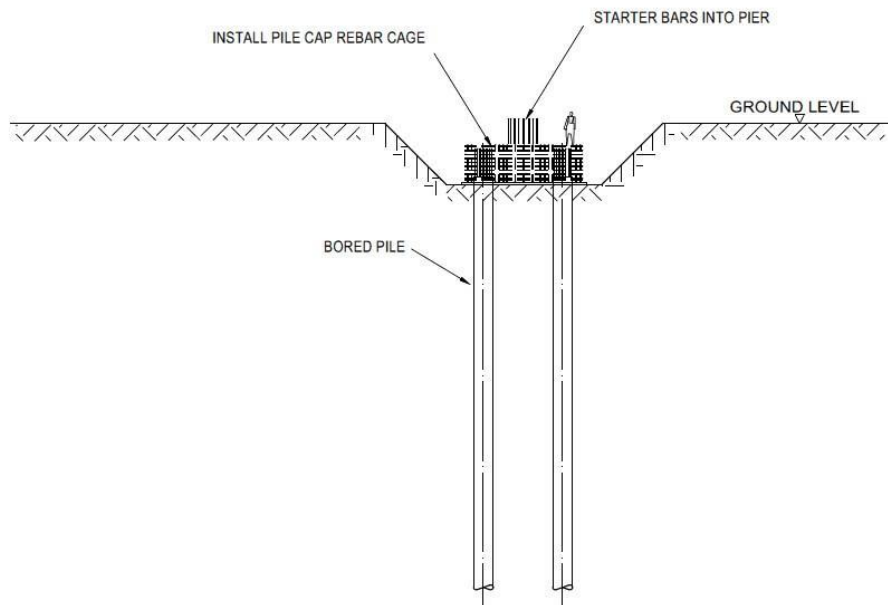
Instalación de jaula de armaduras del dado y de barras en espera para la pila
